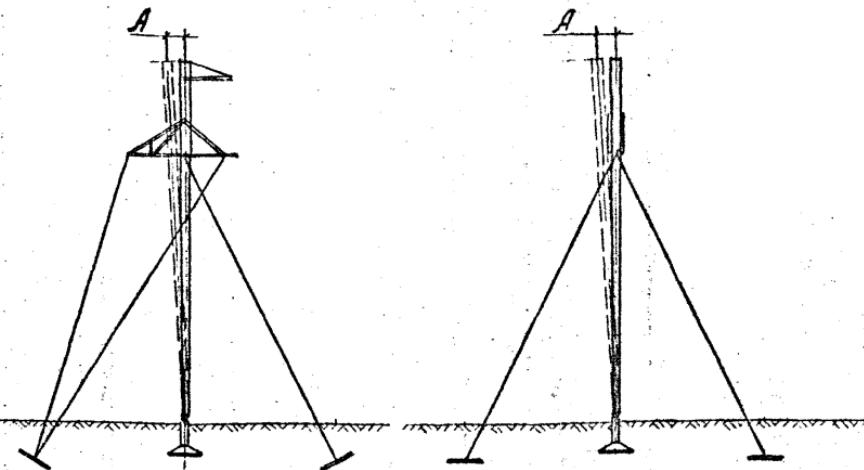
Допуски на установку одностоечных анкерно-угловых железобетонных опор
